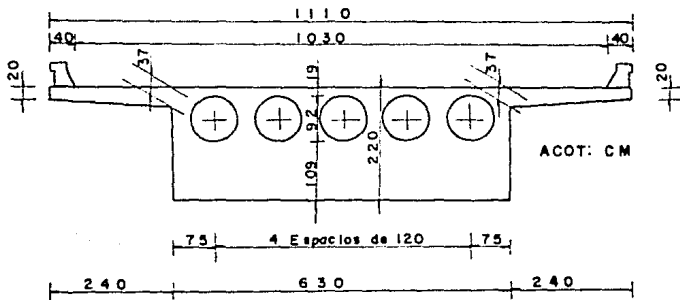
SECCION TRANSVERSAL COLUMNAS
